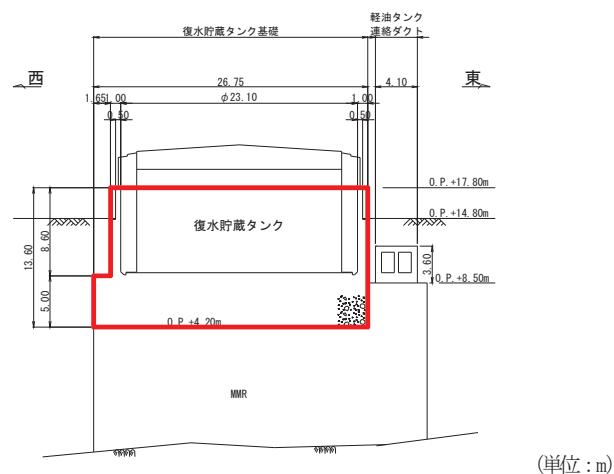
復水貯蔵タンク基礎断面図 (B-B)
